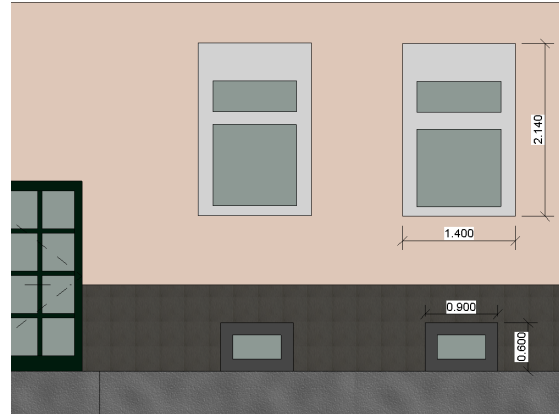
alzado de la fachada principal en el modelo del TFM.
